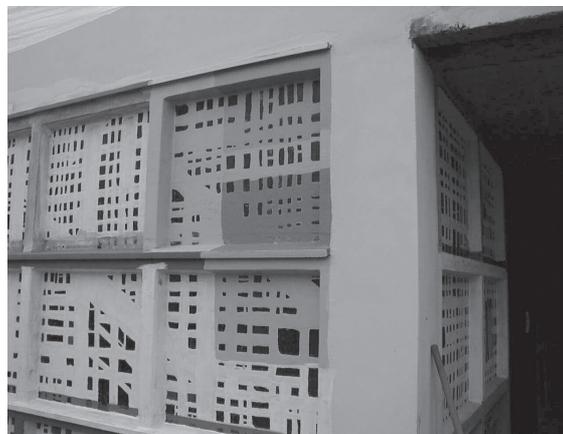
Betonfenster mit Beschichtungs-Farb-
